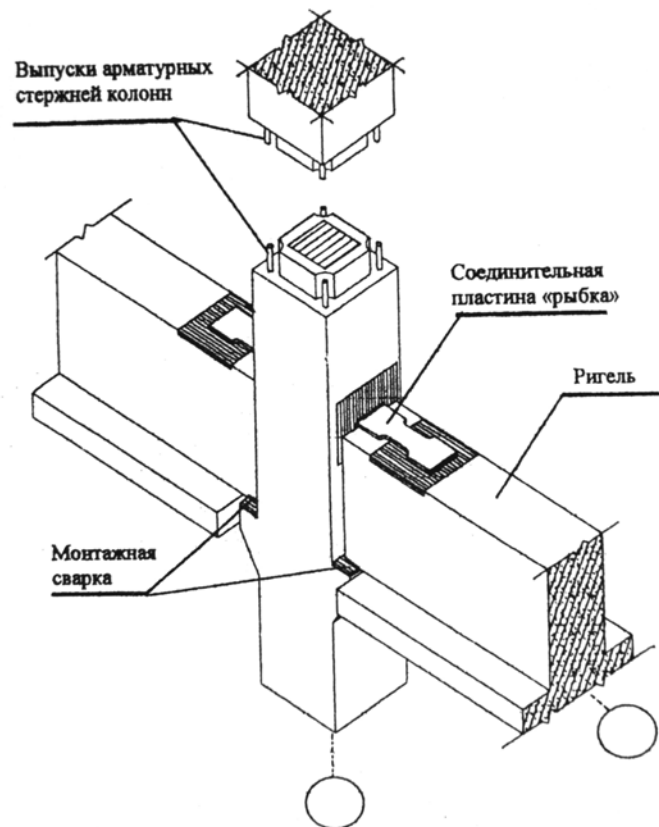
Общий вид конструктивного решения шарнирного стыка на «рыбке»
